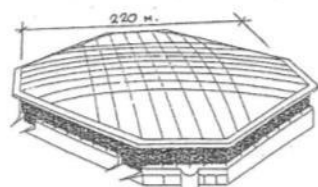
Pontiac Stadium, Michigan. Esquema de la cubierta neumática y detalle del encuentro de ésta y el cable.
